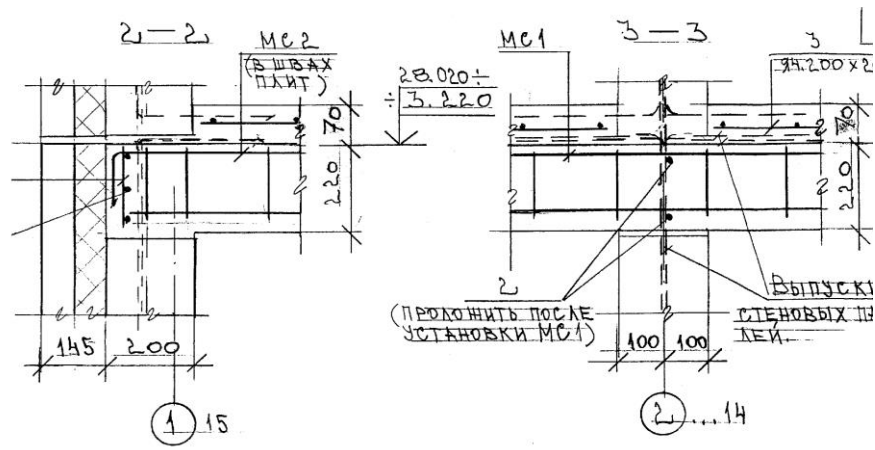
Обпирания плиты перекрытия на внешнюю стену (разрез наведенный по пустоте плиты)
